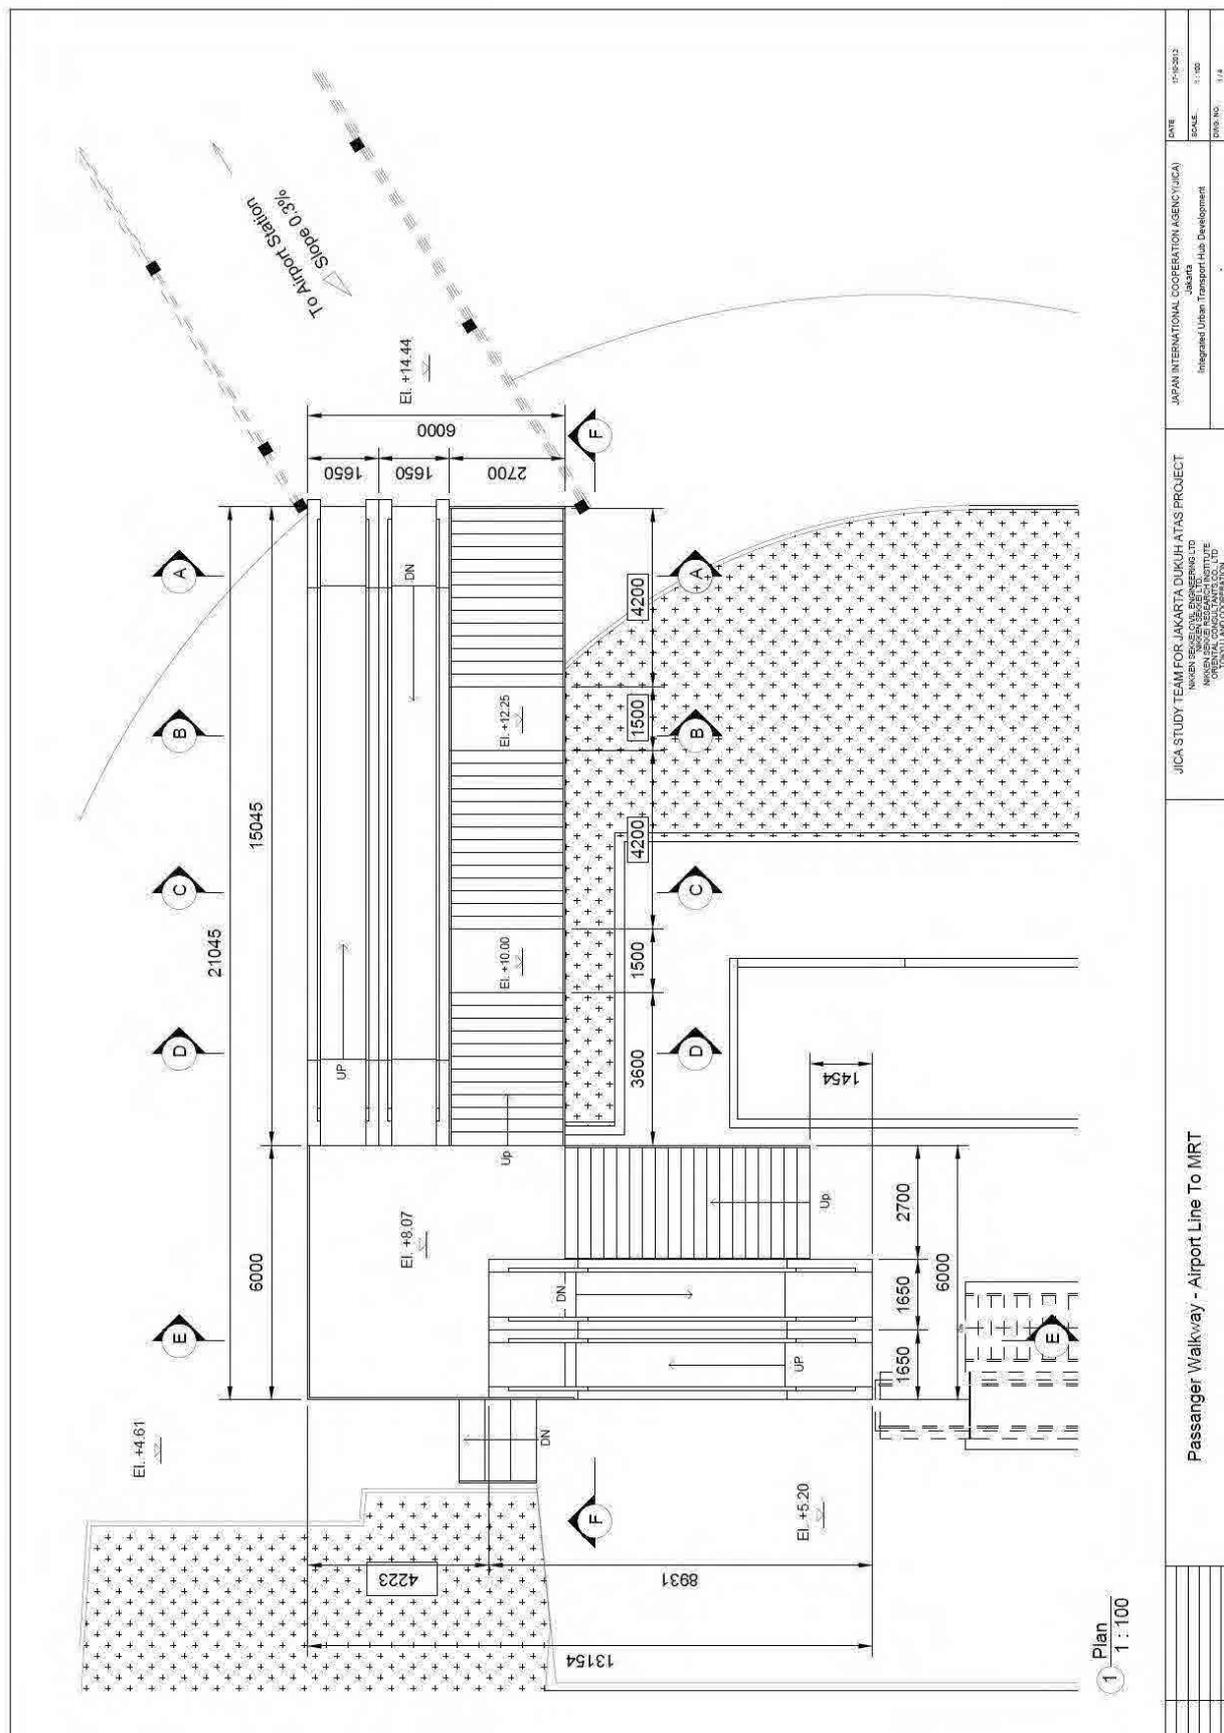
空港線-MRT 南北線連絡通路階段平面図
